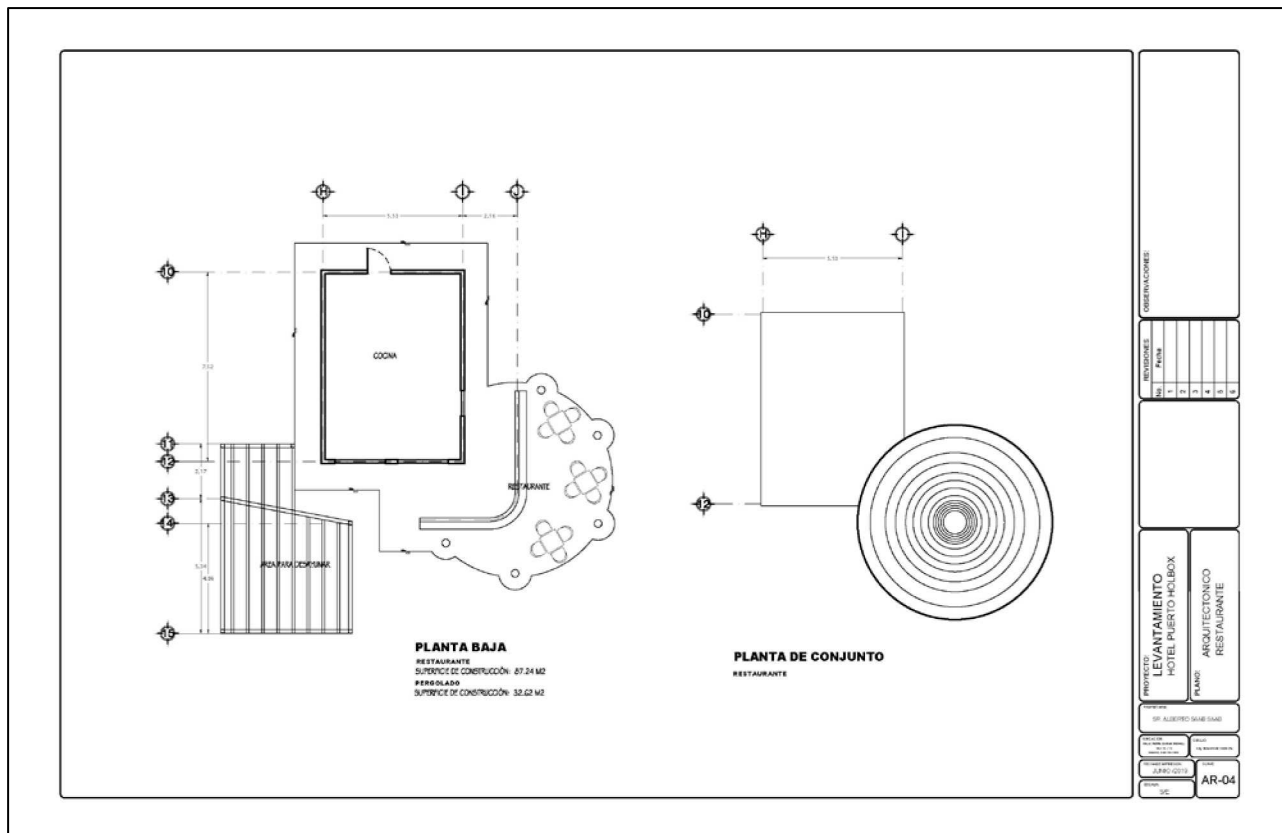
Plano planta baja y planta conjunto de la construcción 6
